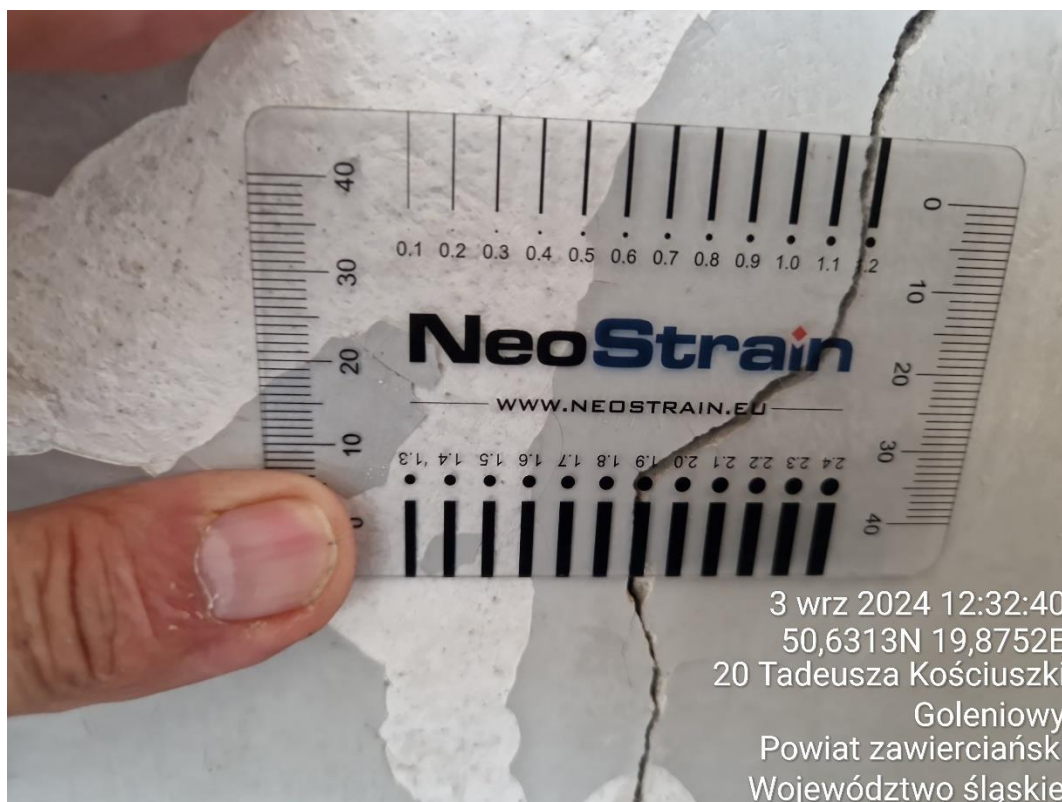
Widok zarysowań elewacji północnej cz. I.
